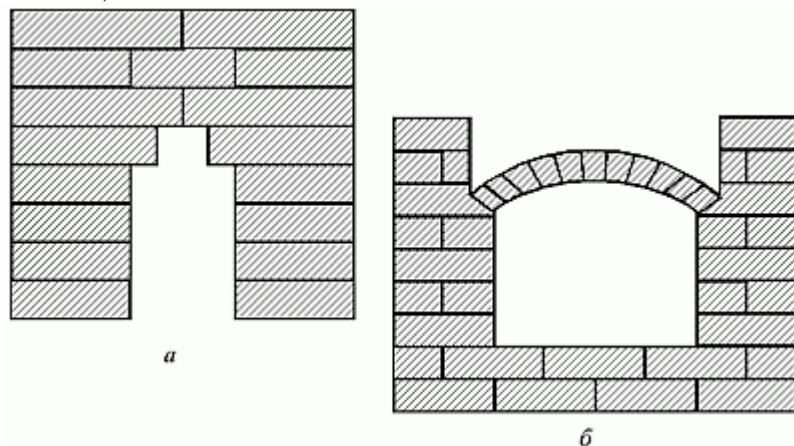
Печные перекрытия: а – на выпусках; б – арочное (свод)
